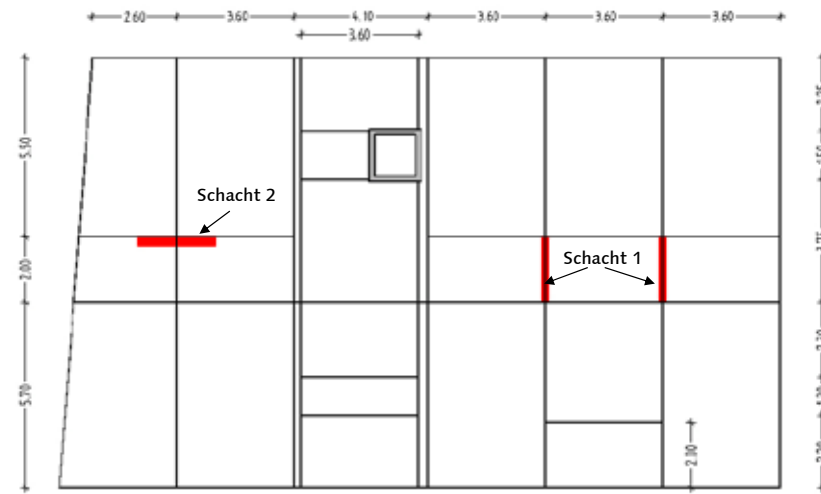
Positionierung Versorgungsschächte im Grundriss [m]
